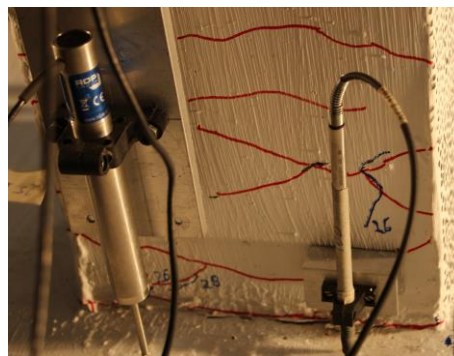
Fissures verticales de compression sur la face latérale gauche de la colonne C2B au LS32
